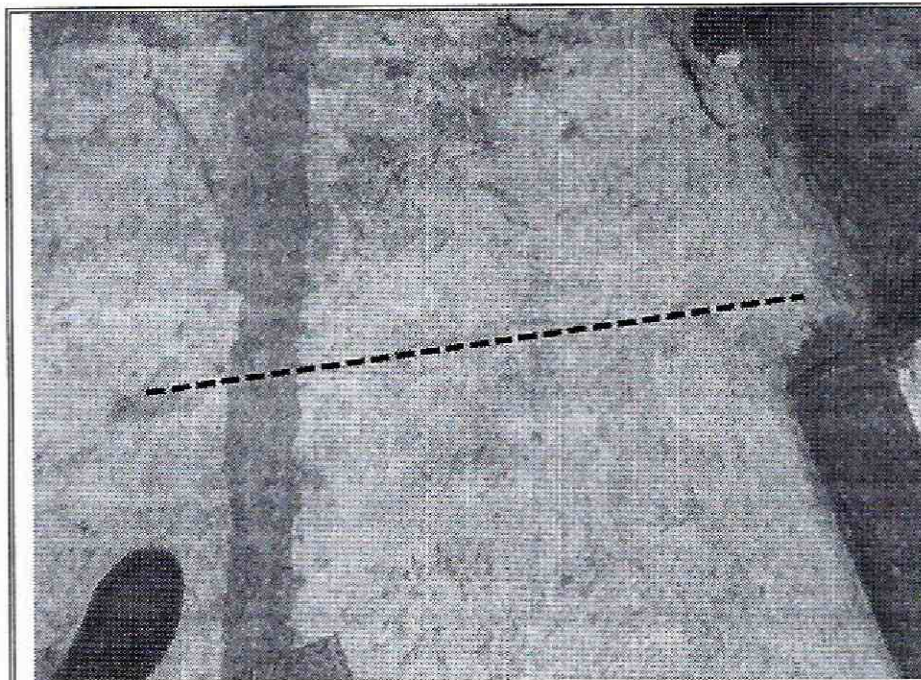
Presencia de fisuras, de tendencia horizontal, en la placa de piso de la vivienda.
